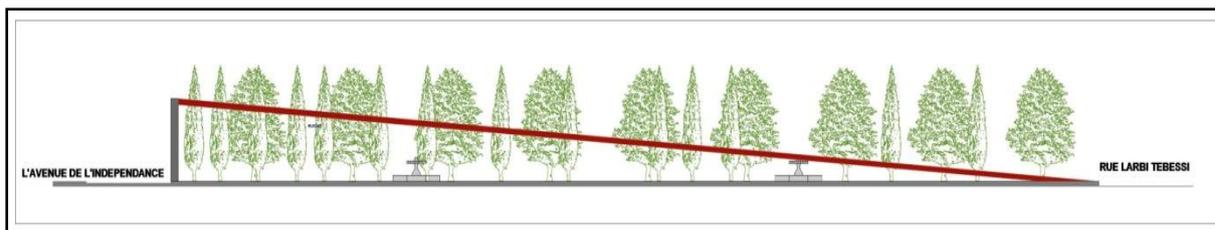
Coupe qui montre le rapport entre la longueur de la place et la hauteur de l'élément qui marque l'entrée. Source : Auteur 2011.
